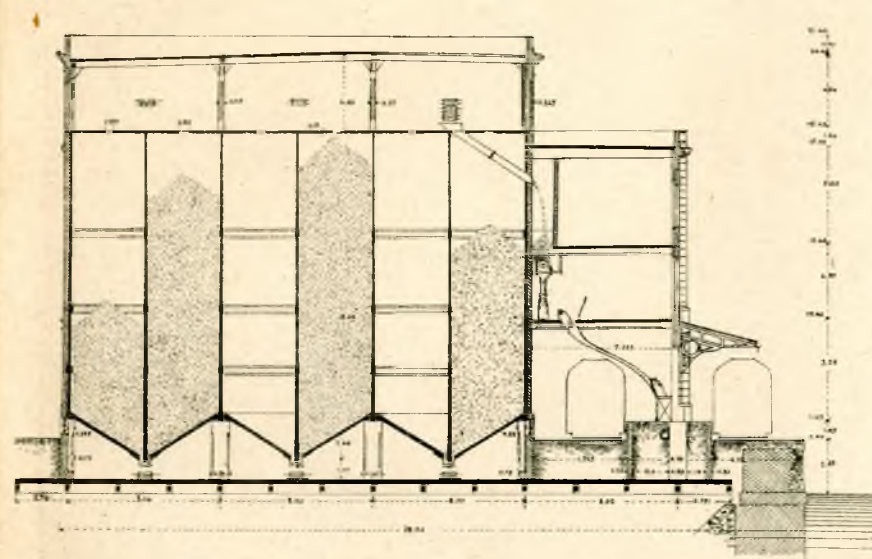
Sezione trasversale secondo A D. Scala di 1 a 400.
